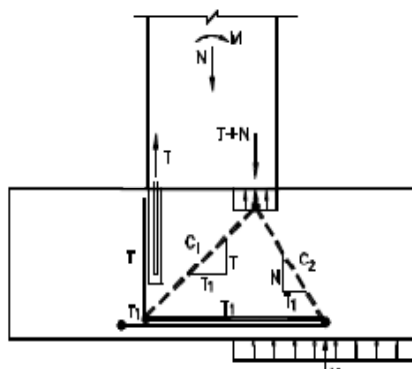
Ligação pilar - fundação com armaduras salientes do pilar (extraída de [3])
